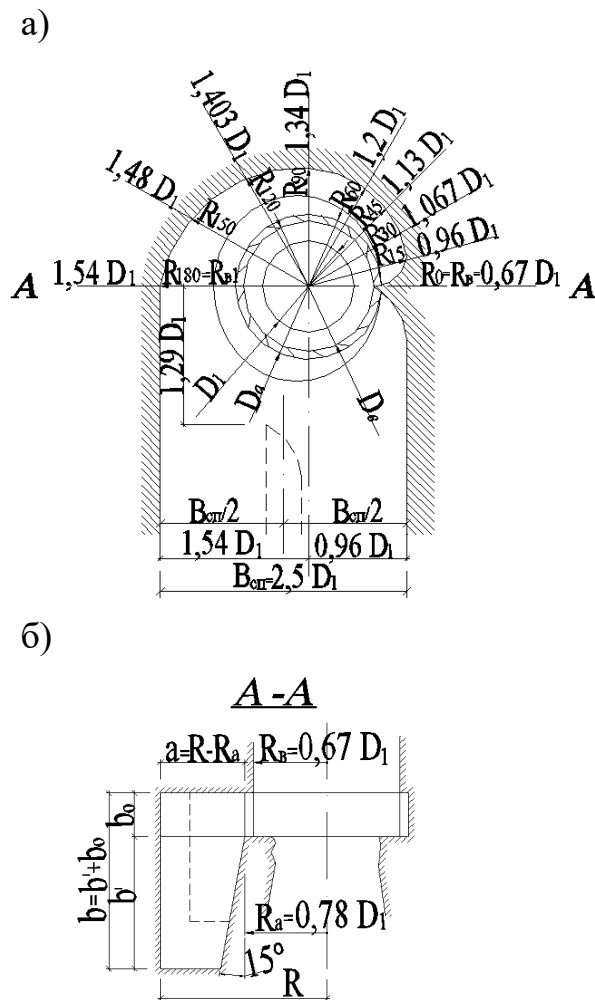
Схема турбінної камери з бетону: а – план; б – поперечний переріз
